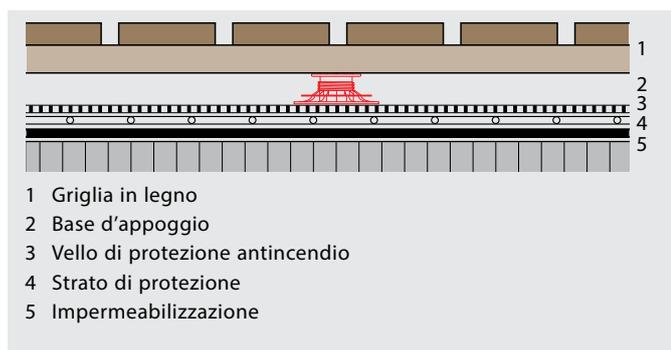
Struttura del sistema di una griglia in legno su struttura per tetto piano con isolamento termico.
